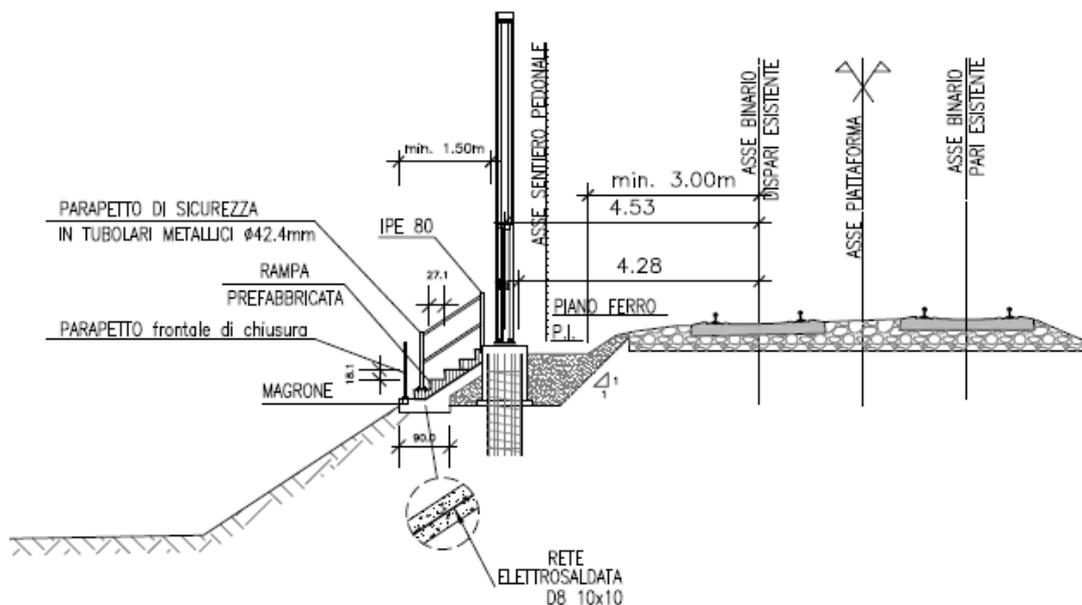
Predisposizione accesso al sentiero pedonale in linea
